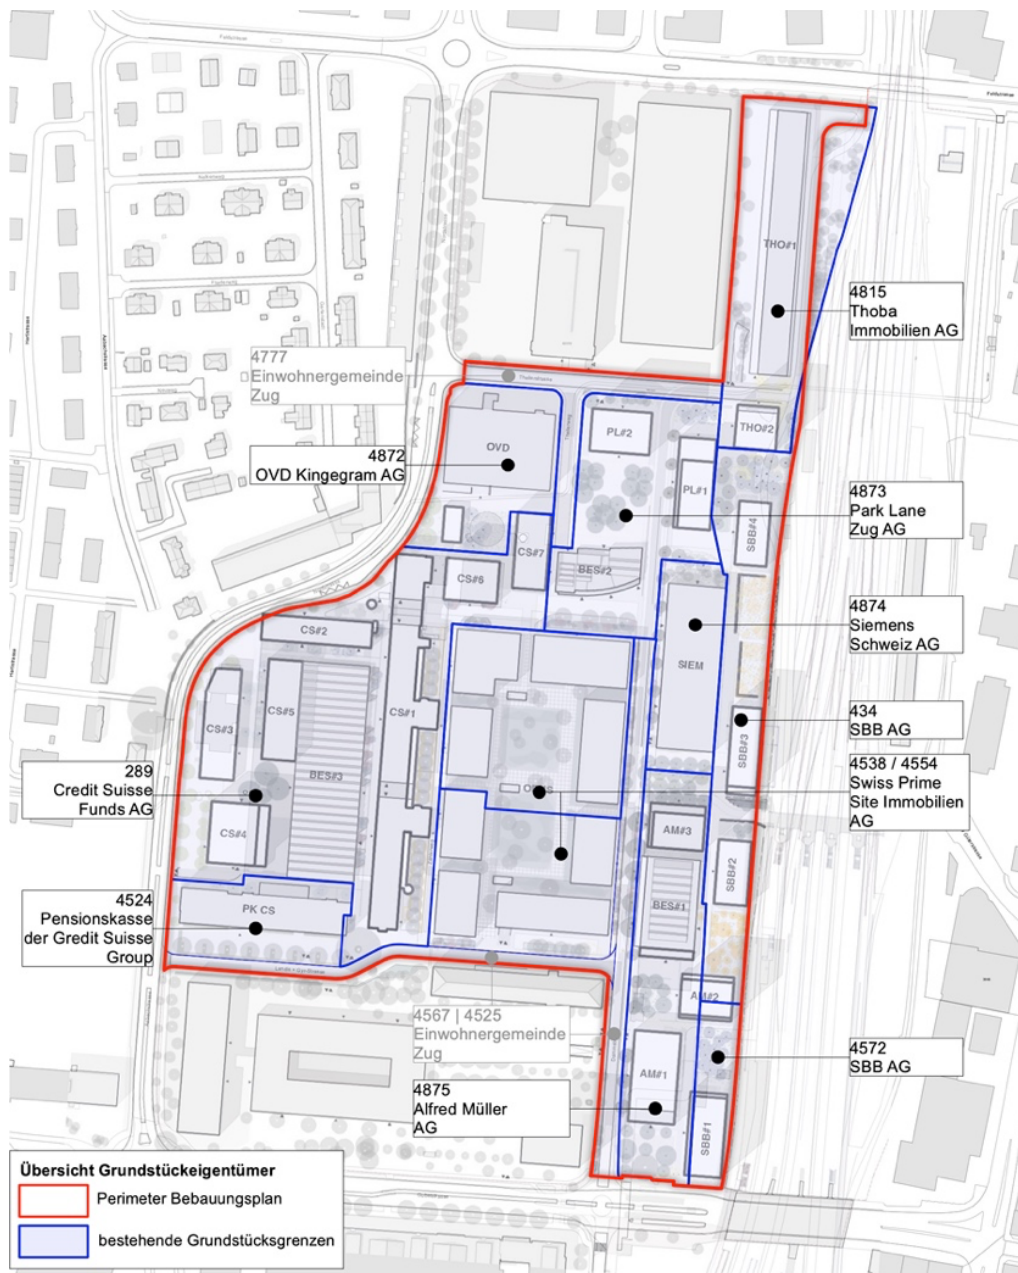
Übersicht Grundeigentümer im Bebauungsplanperimeter
